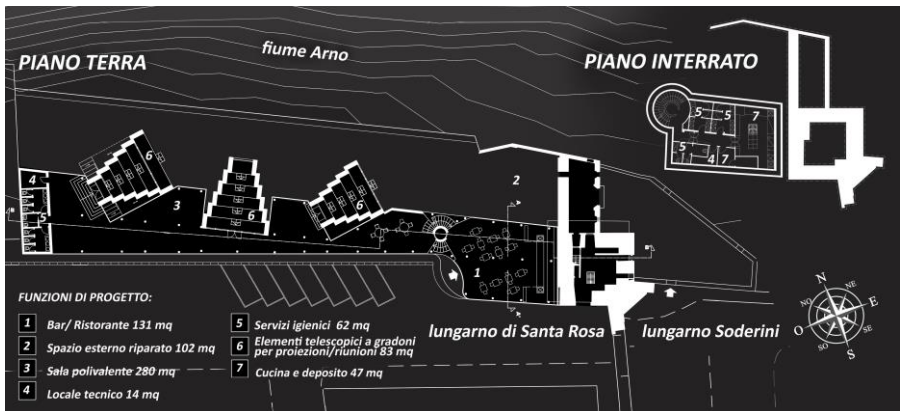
Pianta del piano terra e del piano interrato, stato di progetto.
